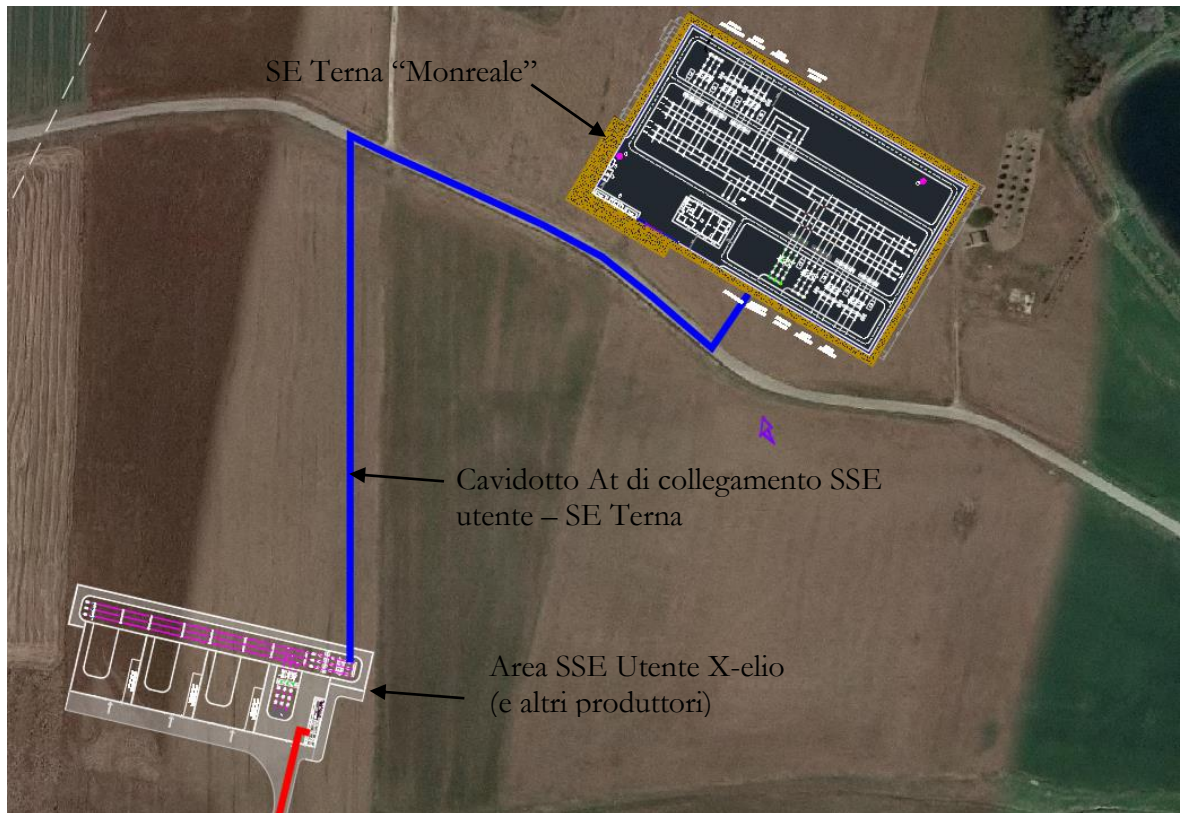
Planimetria con individuazione nuova SSE e elettrodotto di collegamento alla SE Terna esistente
